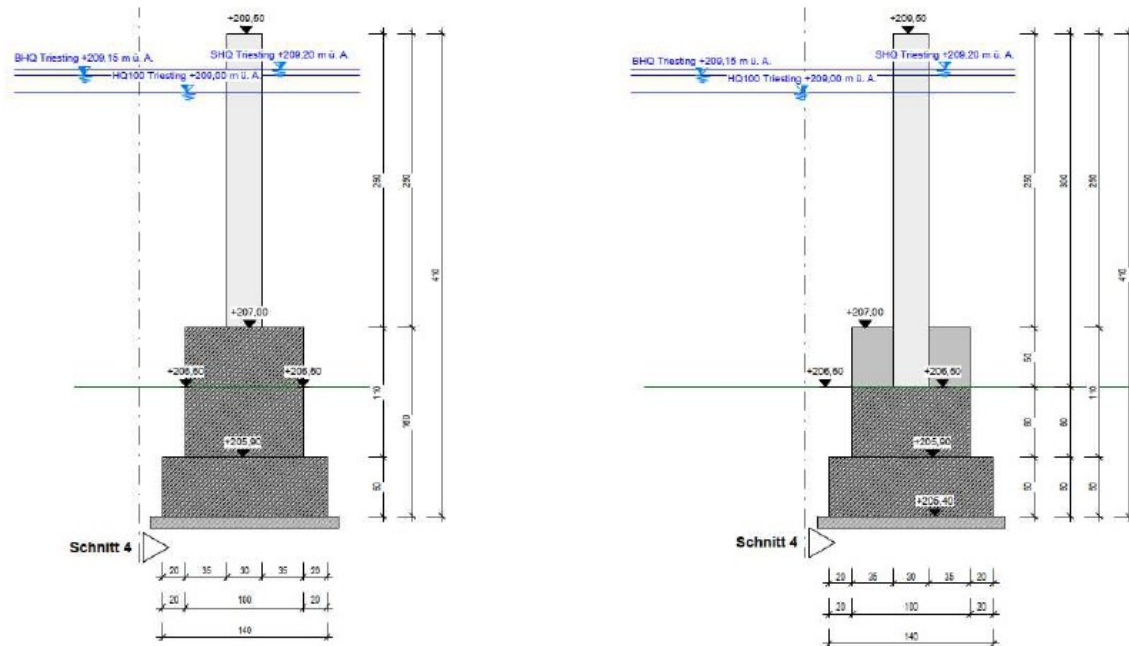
Schnitte durch die Rechenanlage ([13], Kap.7.5.1, Abb.35)
